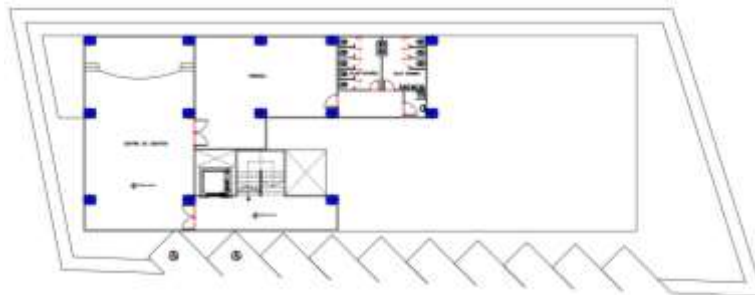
Planta Arquitectónica, Primer Planta Alta
